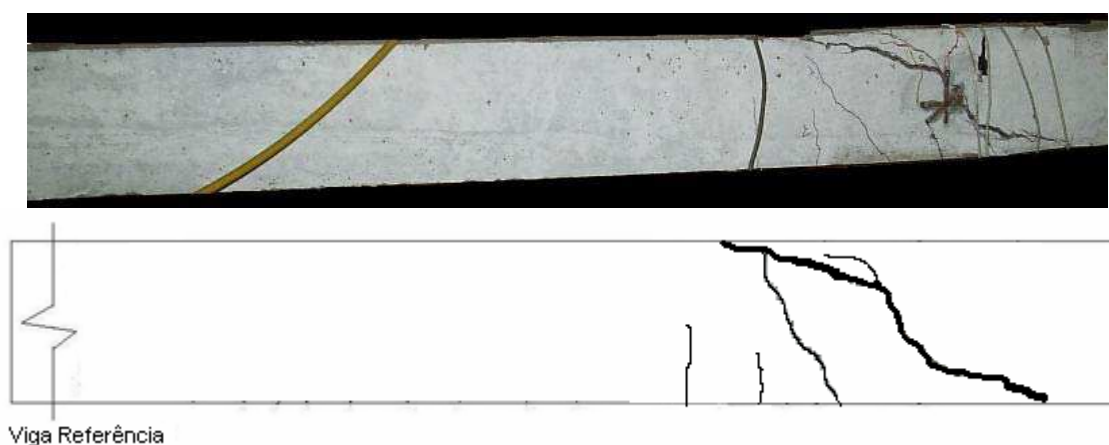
Panorama de fissuração da Viga Referência.
